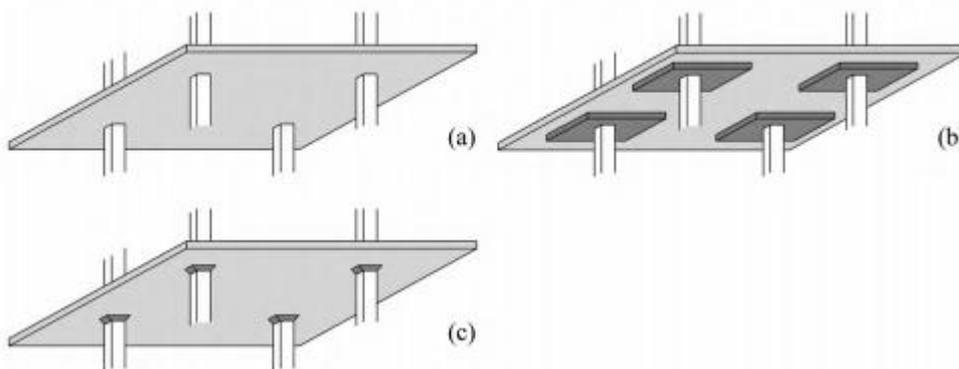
système de plaque: (a) sans chapiteaux, (b) avec chapiteaux, (c) avec goussets⁶⁶
